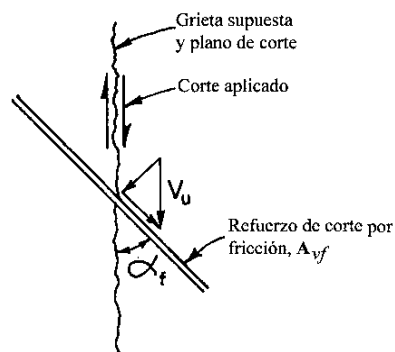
Refuerzo de corte por fricción formando ángulo con la grieta supuesta
